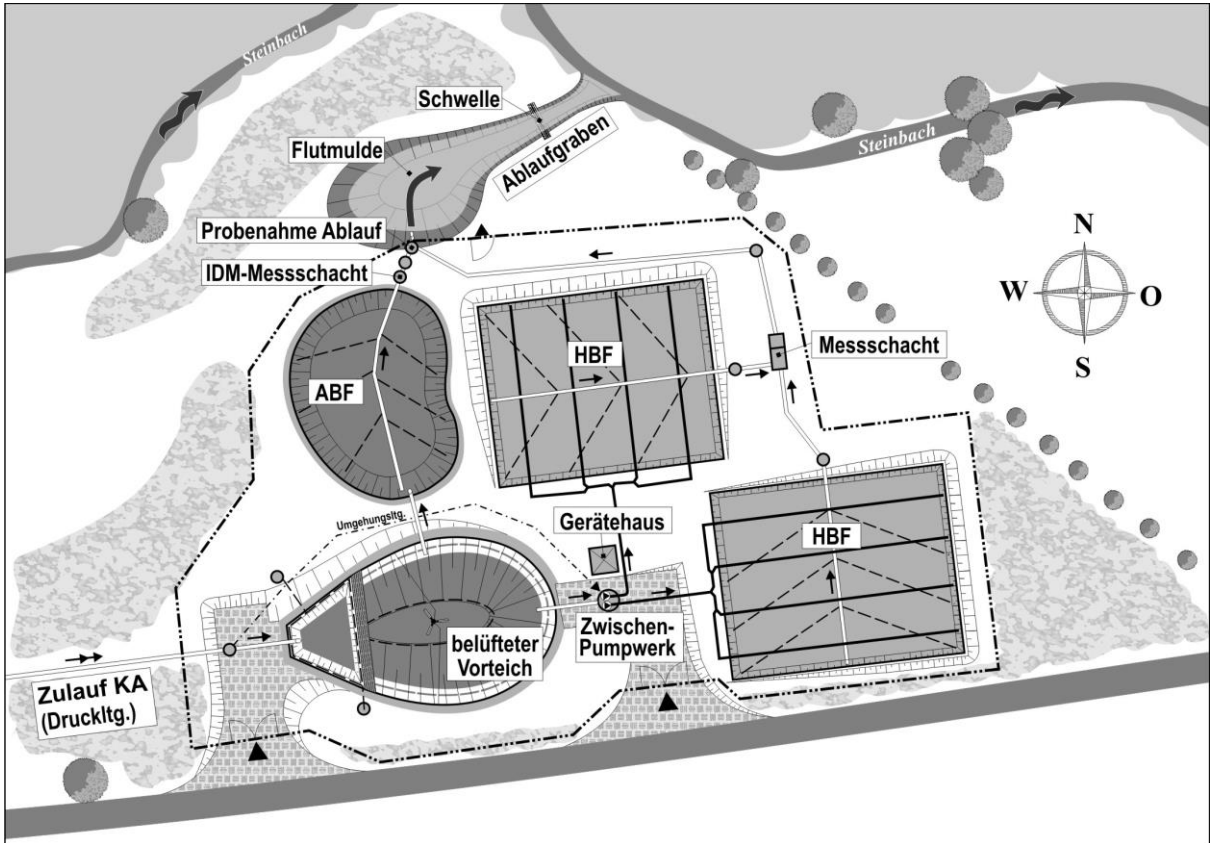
Lageplan zur Kläranlage Büschdorf
